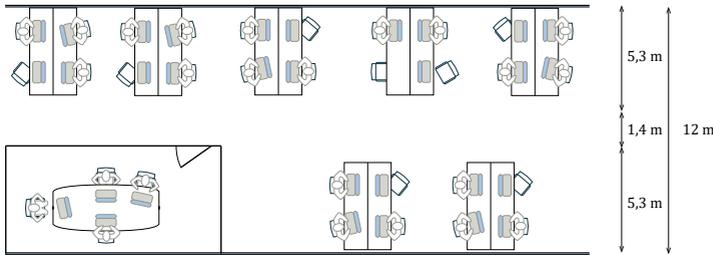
Organisation d'un plancher avec une profondeur de 12 m
